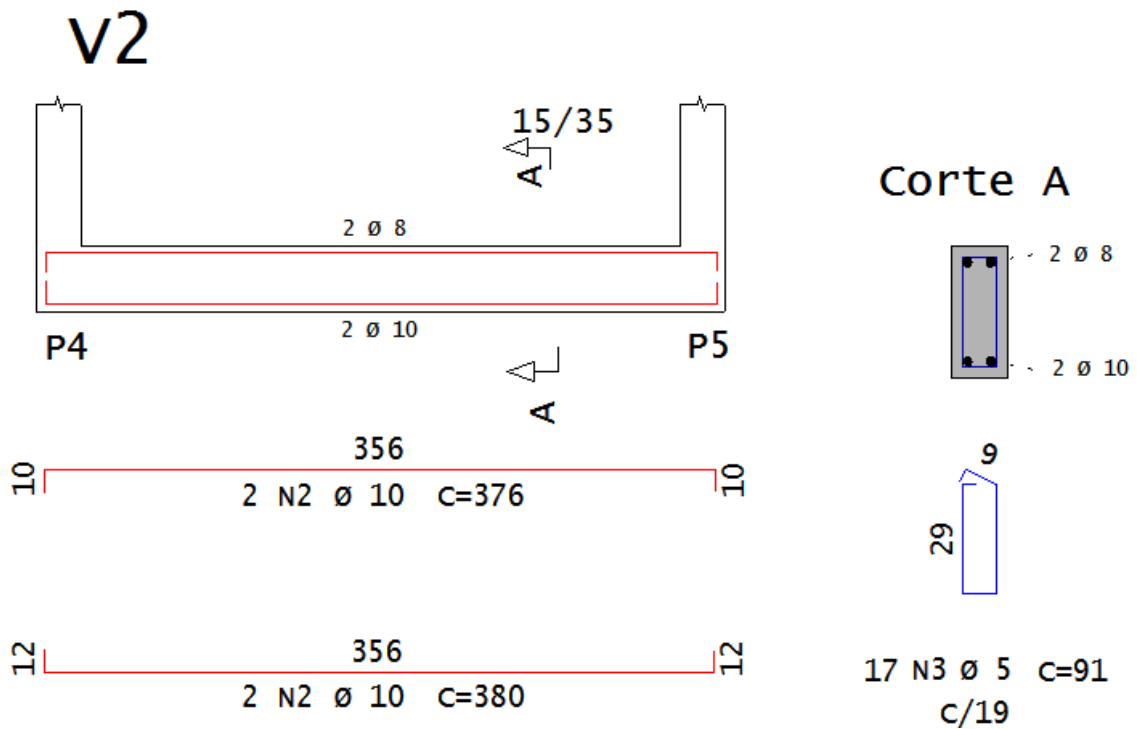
Detalhamento das armaduras na seção da viga 2 com base na NBR 6118 (2014)
